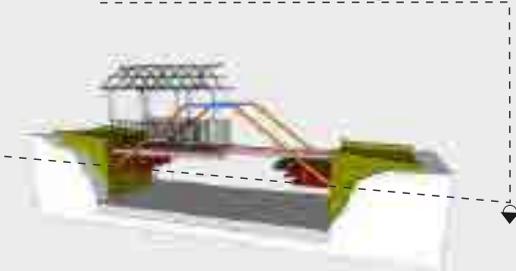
Plano y perfil de in puente de madera 1750 AGM, SMP4, REF:366A
